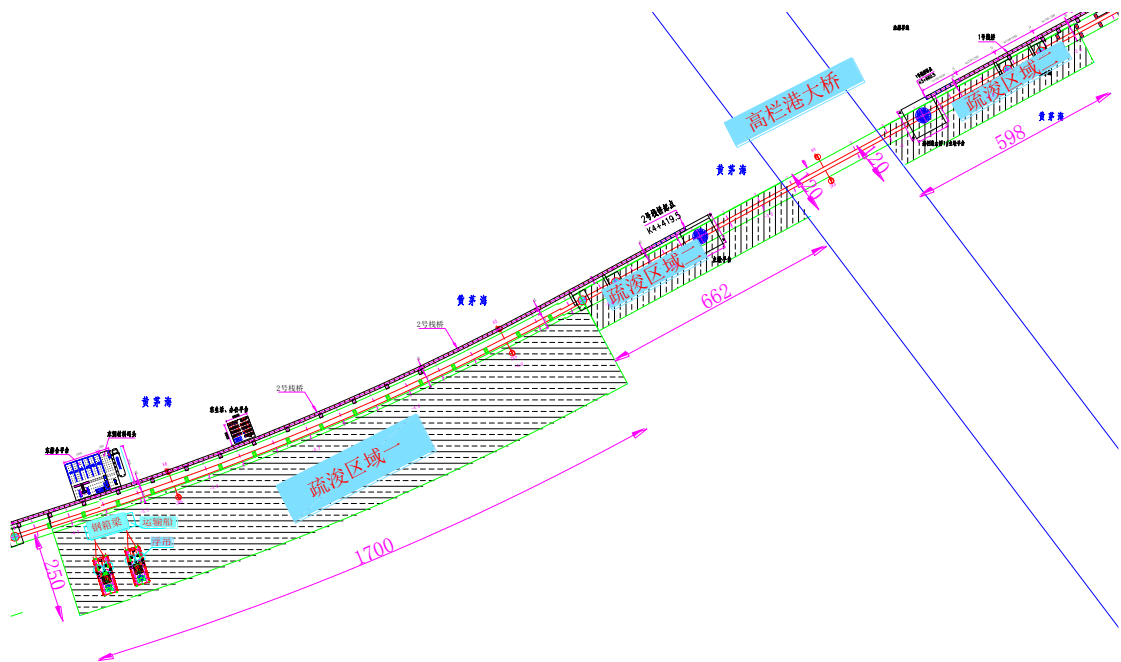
中引桥及主桥疏浚疏浚平面图
